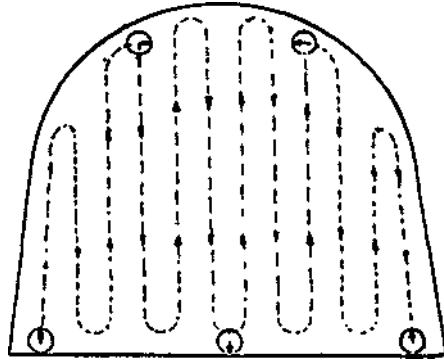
Havayolu Kesit Alanı Ölçmelerinde Kullanılan Plançete ve Detayları
